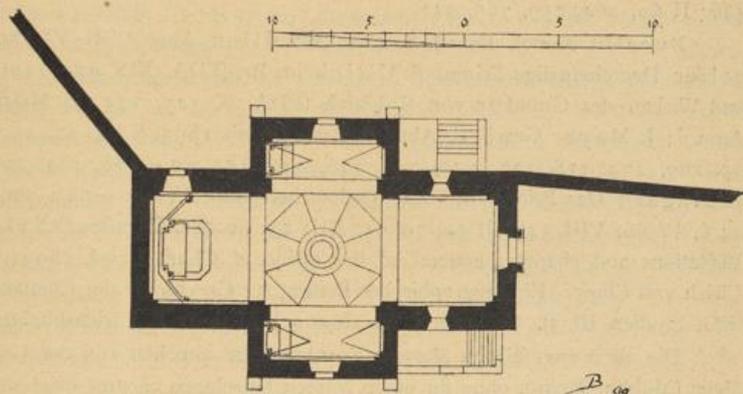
S. Trudpert. S. Trudpertskapelle. Grundriss.
